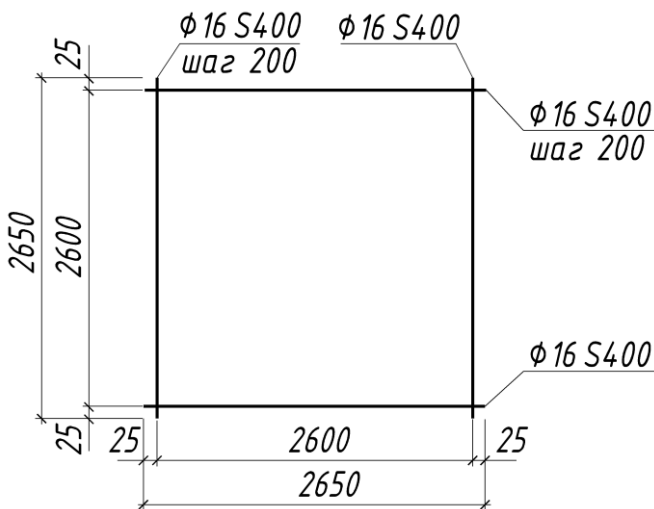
Сетка С1 для армирования плиты фундамента
